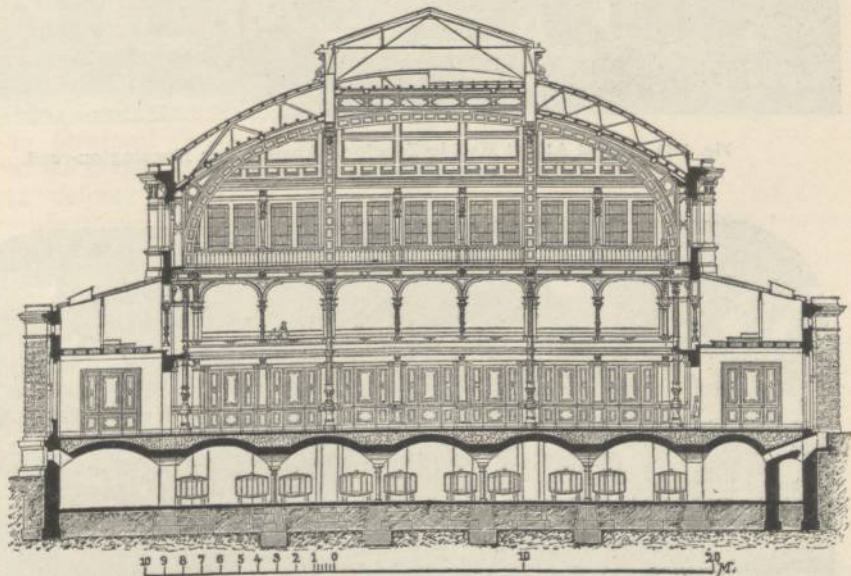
Stadthalle in Mainz. Querschnitt (Architekt Kreyssig).
